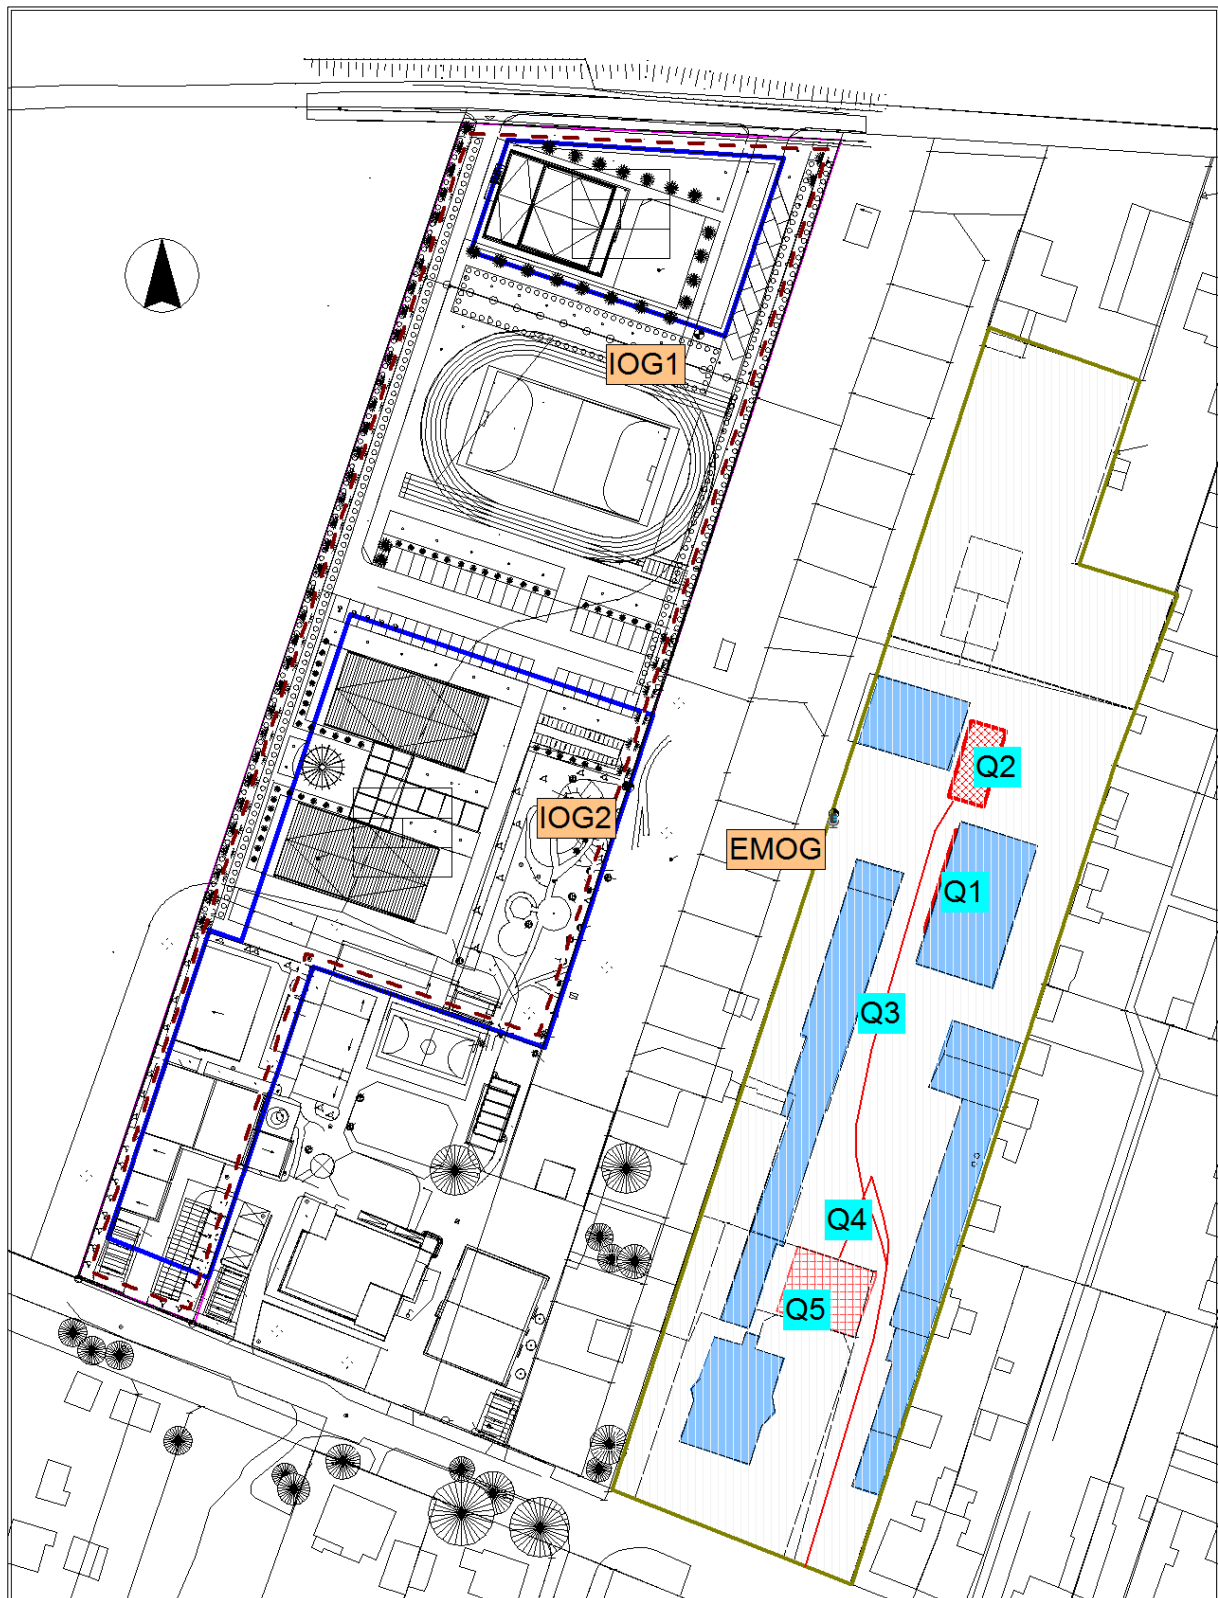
Lage- und Quellenplan Gewerbe mit Nachweisorten IOG
